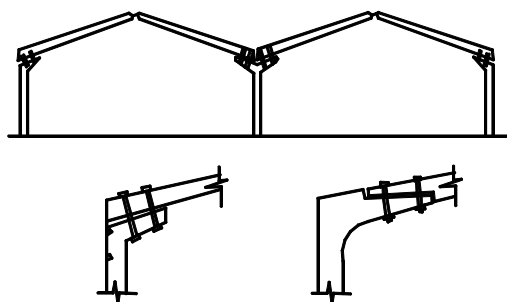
Универсальная конструкция каркаса из сборных железобетонных элементов с узловыми соединениями на болтах (Англия)
